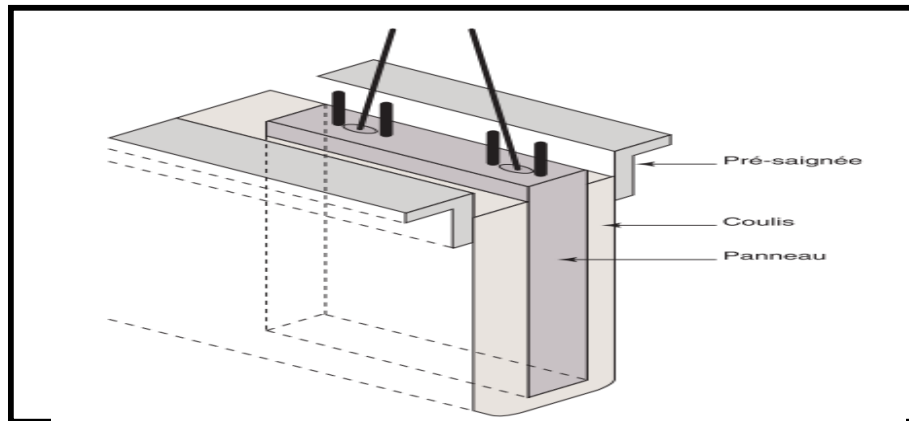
Principe de construction d'une paroi moulée préfabriquée
